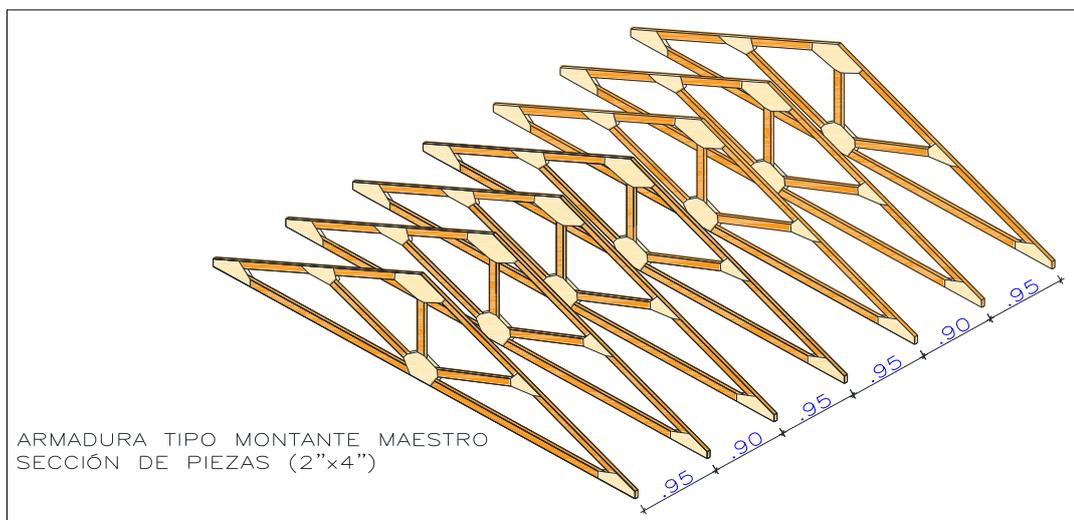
Distribución del montaje de las armaduras de madera tipo Montante Maestro
